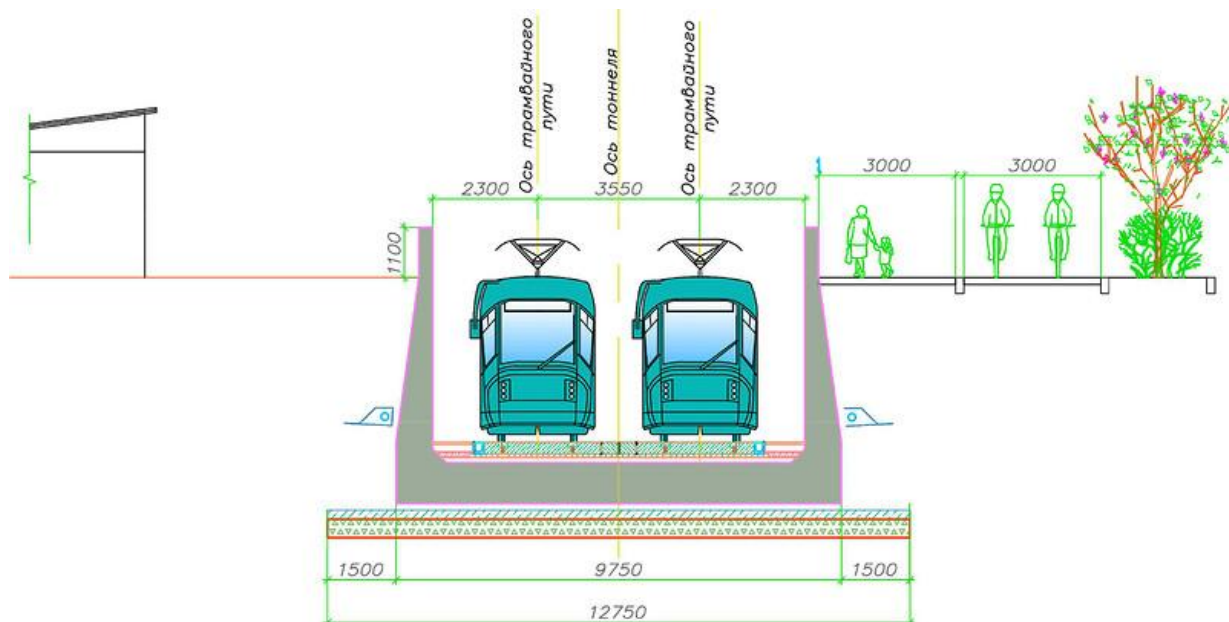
Поперечный разрез путепровода тоннельного типа на пересечении с ул. Дальняя
